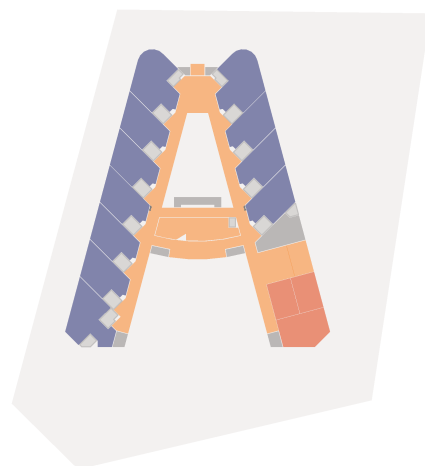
Planta do Prieiro Pavimento - Tipo 1.
